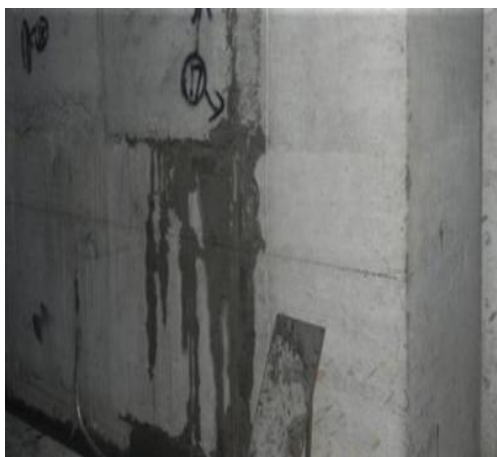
外墙竖向施工缝处裂缝渗漏水
